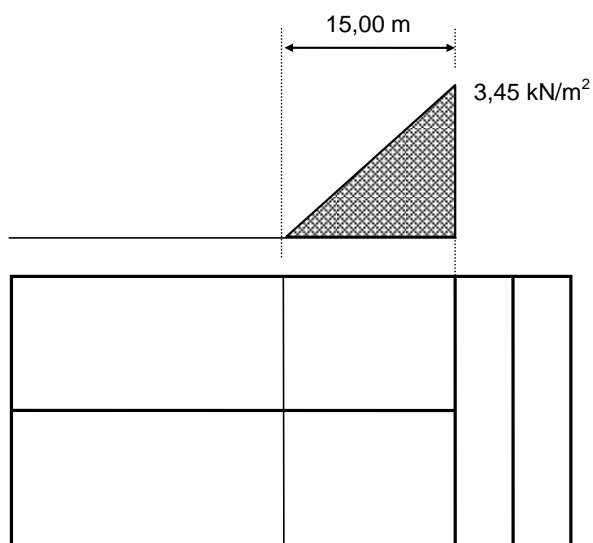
Accumulation exceptionnelle de neige sur la toiture inférieure dans le cas d'une toiture attenante à un bâtiment plus haut
